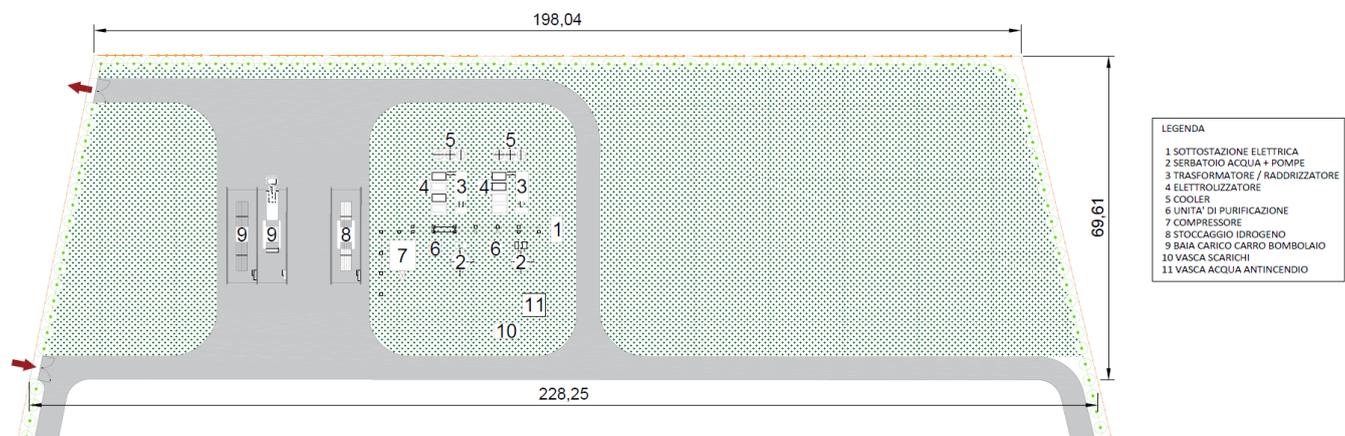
Planimetria preliminare dell'Impianto di Idrogeno Verde di Statte
